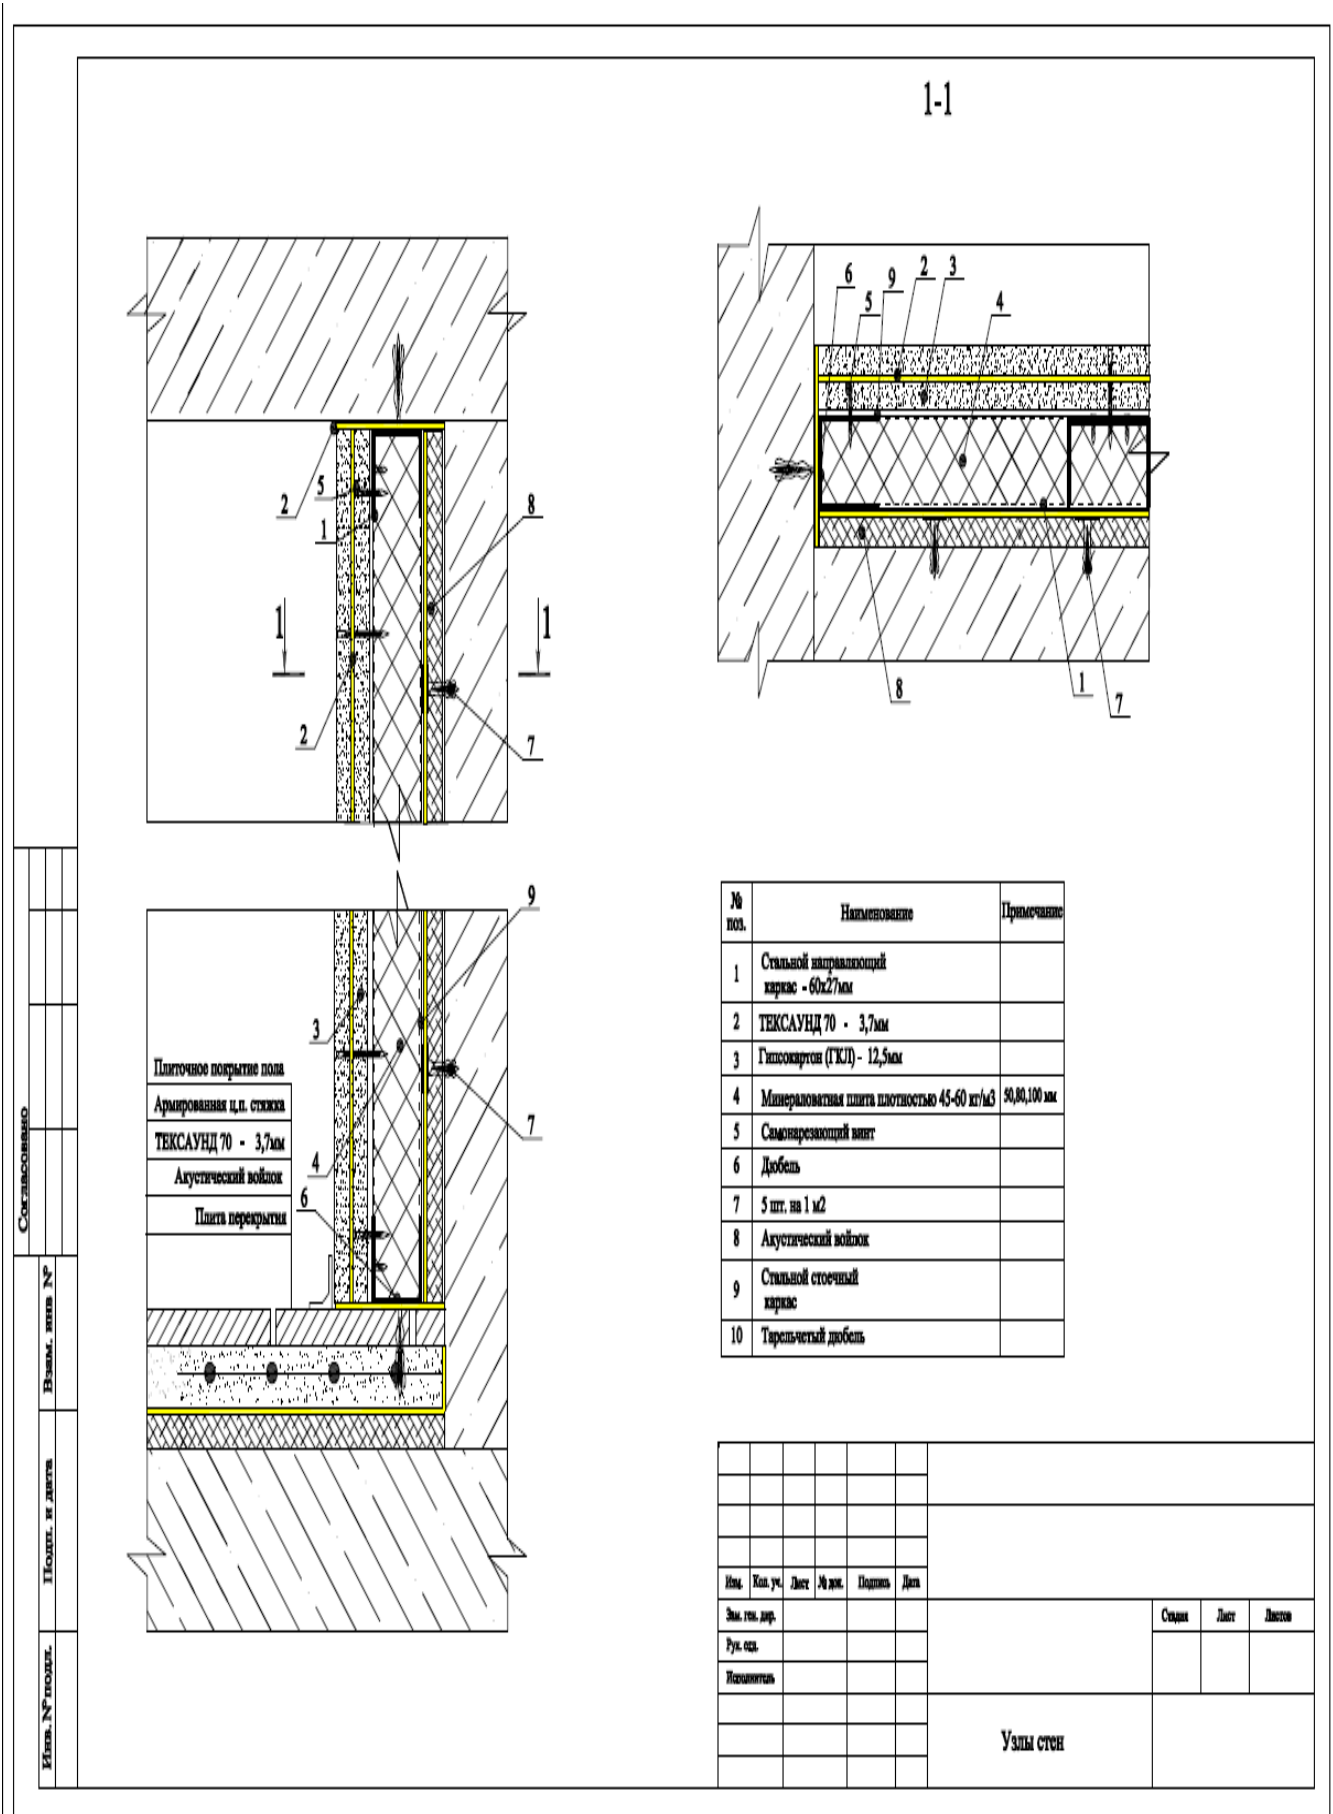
Порядок звукоизоляции стен мембраной от фирмы Тексаунд
